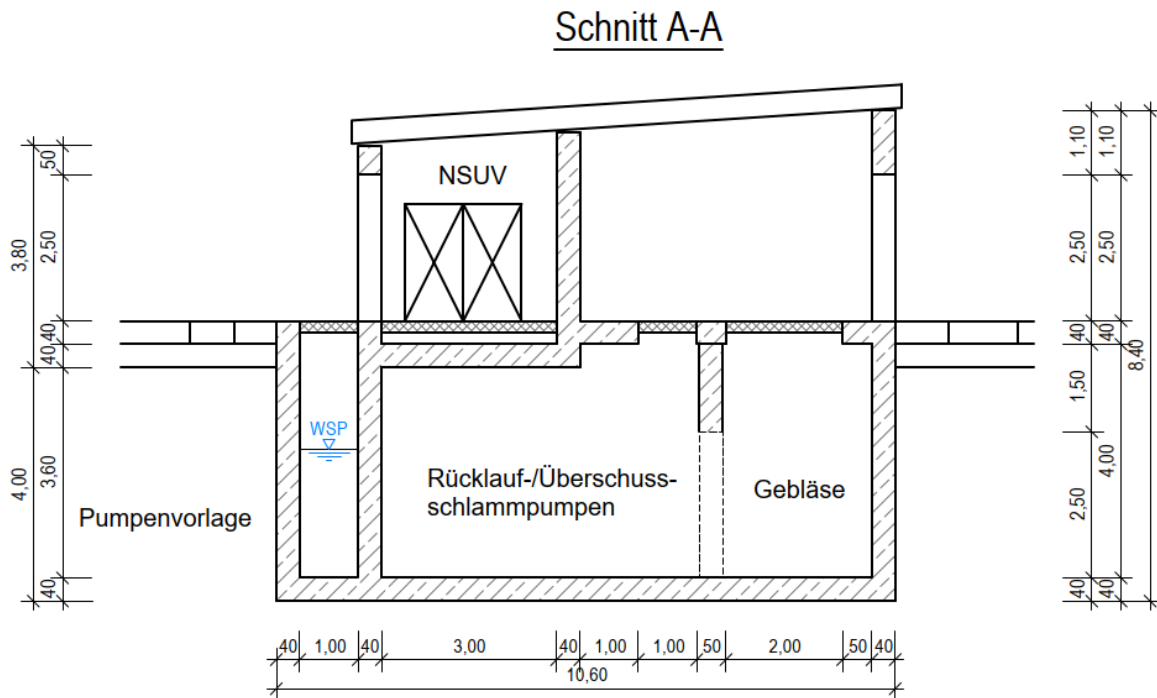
Entwurf – Betriebsgebäude für NSUV, Rücklauf- und Überschussschlammumpen und Gebläse
